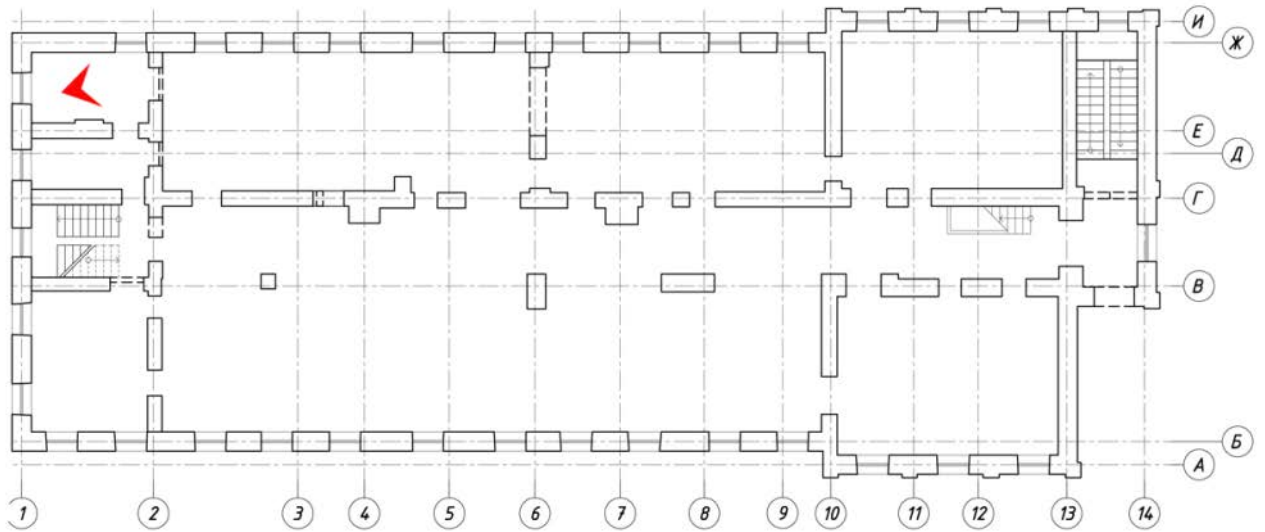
Помещение 2-го этажа в осях 1 – 2/Е – Ж.
